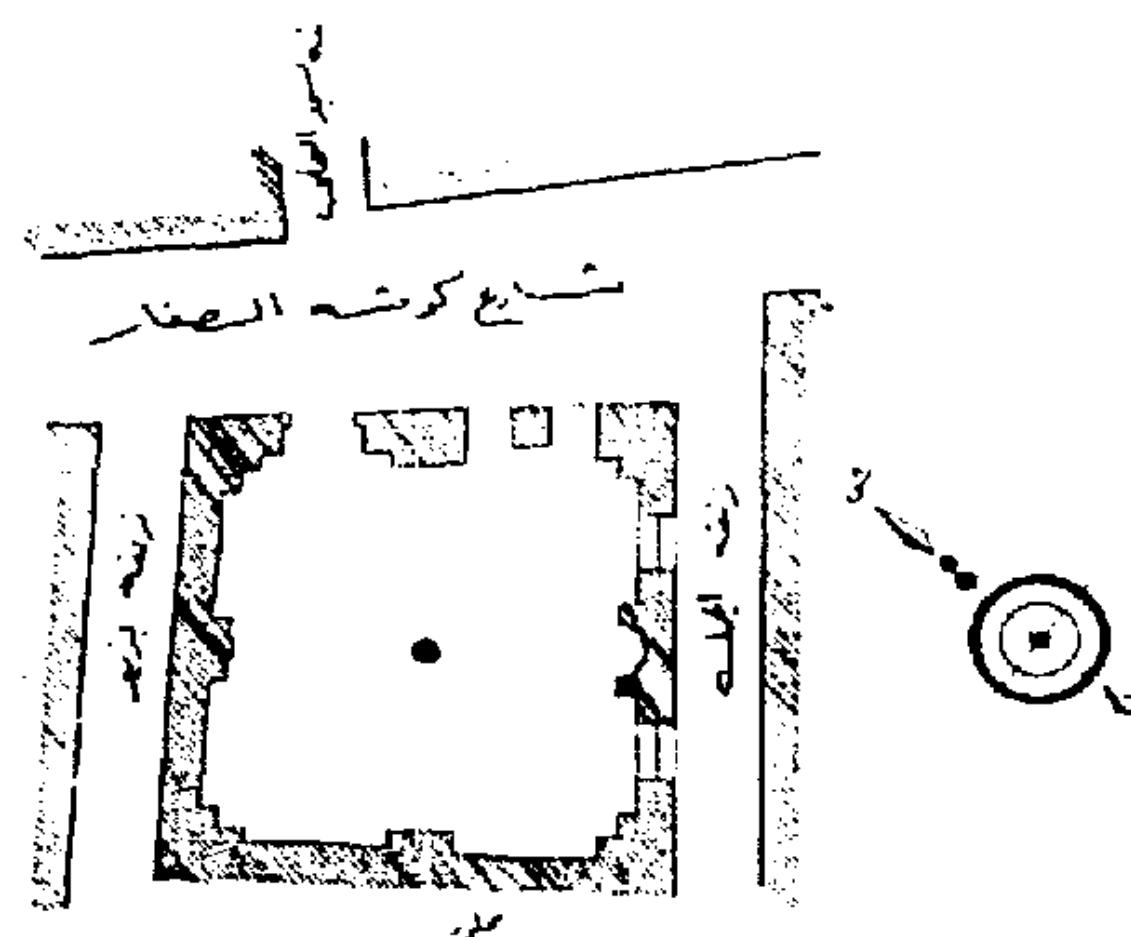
مسقط أفقى لجامع الدباغ عن الموسوعة (الجزء الأول).
